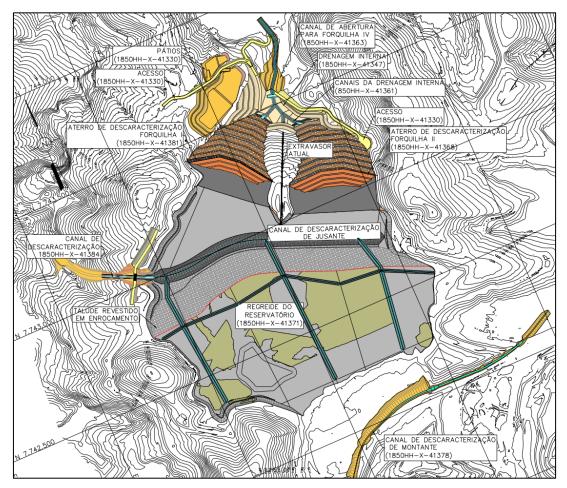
Geometria de descaracterização - Planta. Fonte: 1850HH-X-41548.
